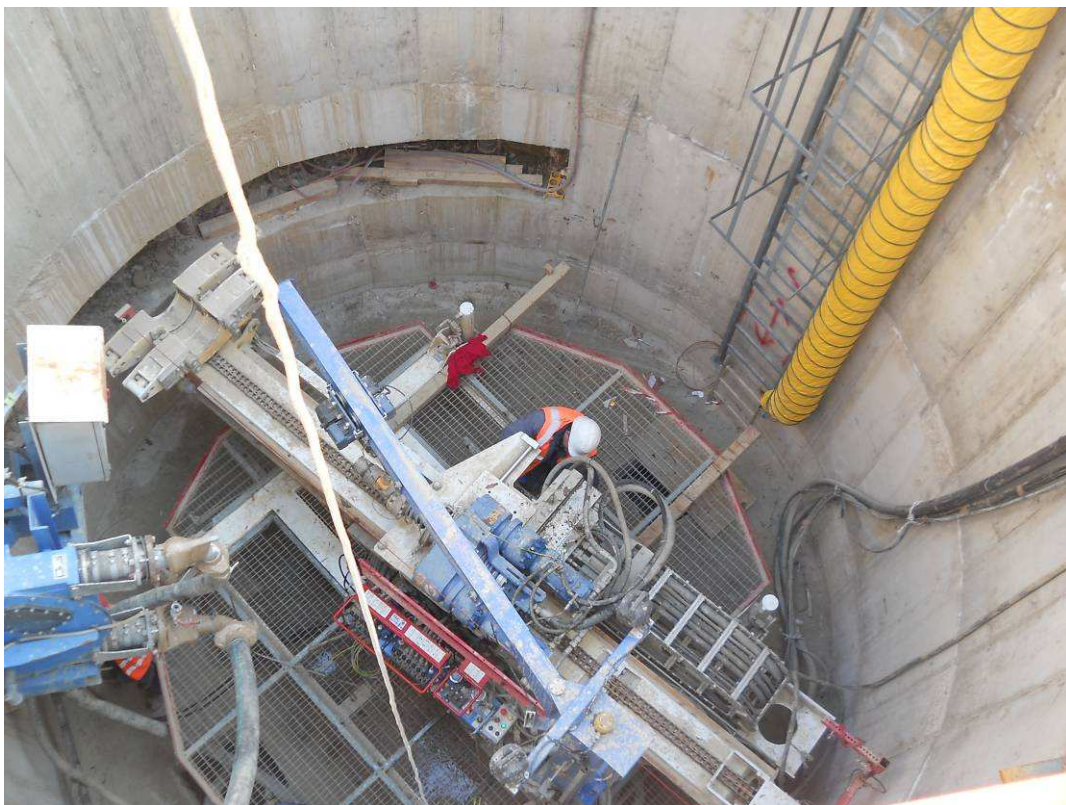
Compensation grouting edifici area Ponte al Pino – perforazioni
